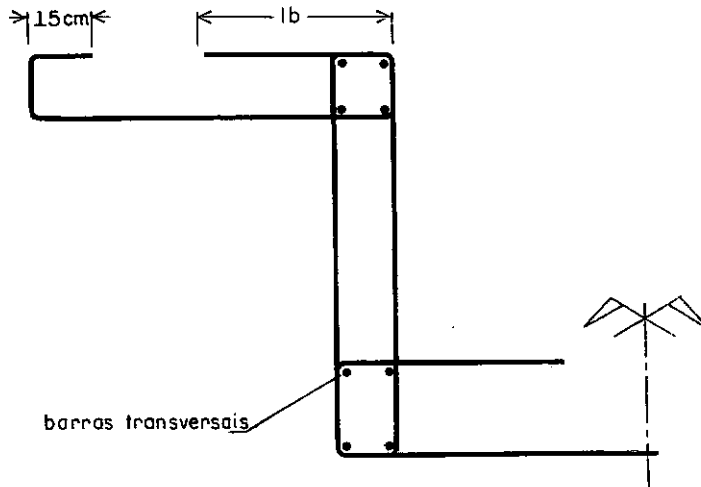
DETALHE DE ARMADURA ADOTADO
